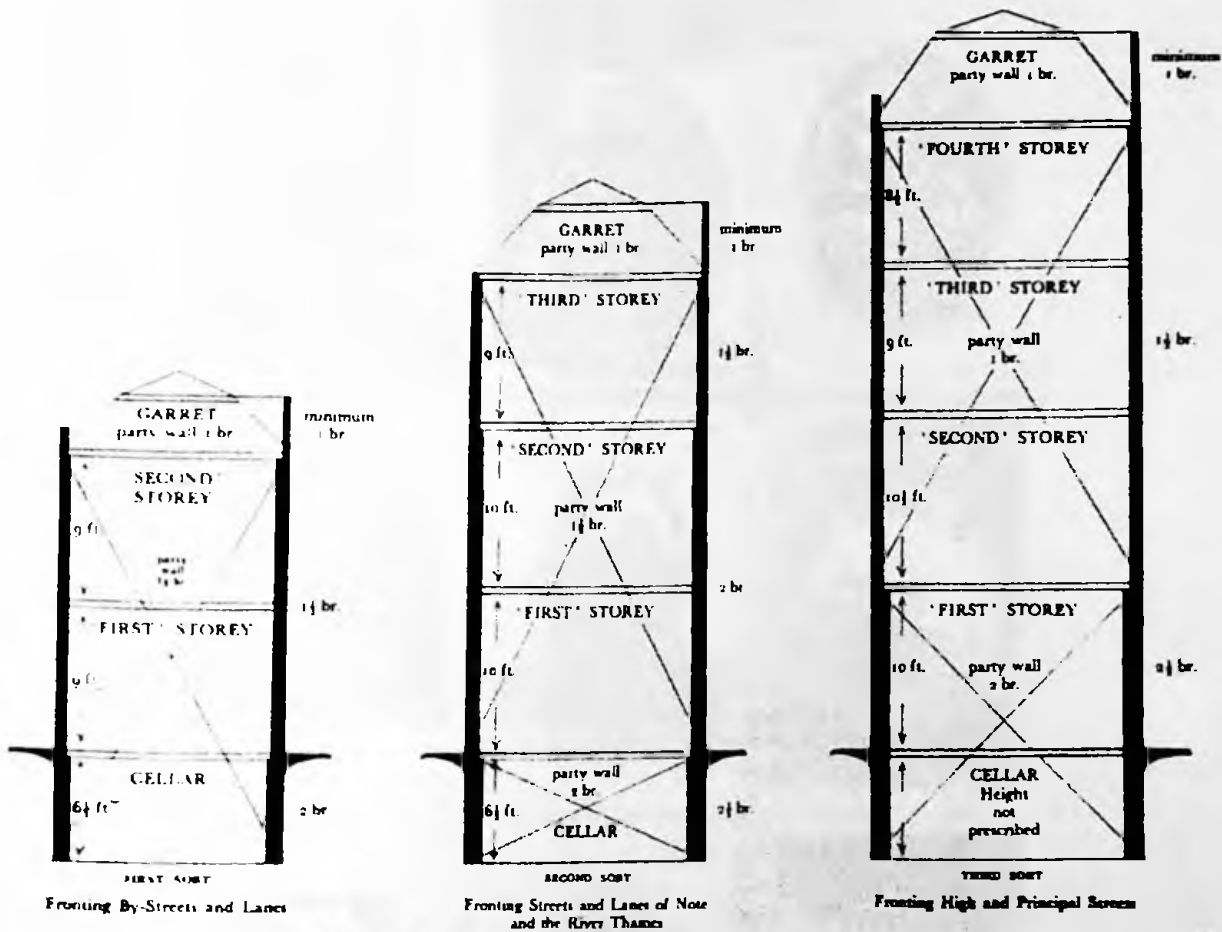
Tipo de construção permitida pelo Rebuilding Act de 1667 (HANSON, 1967)
